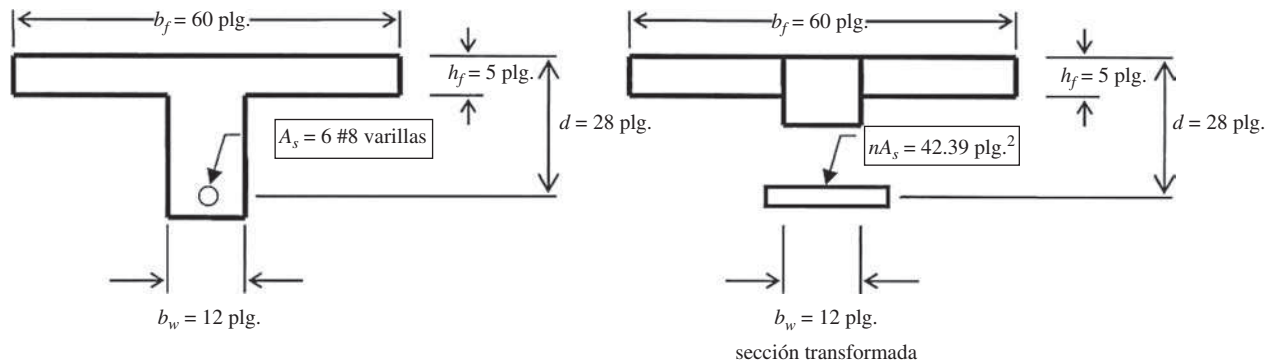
Sección transversal de la viga del Ejemplo 2.5.
